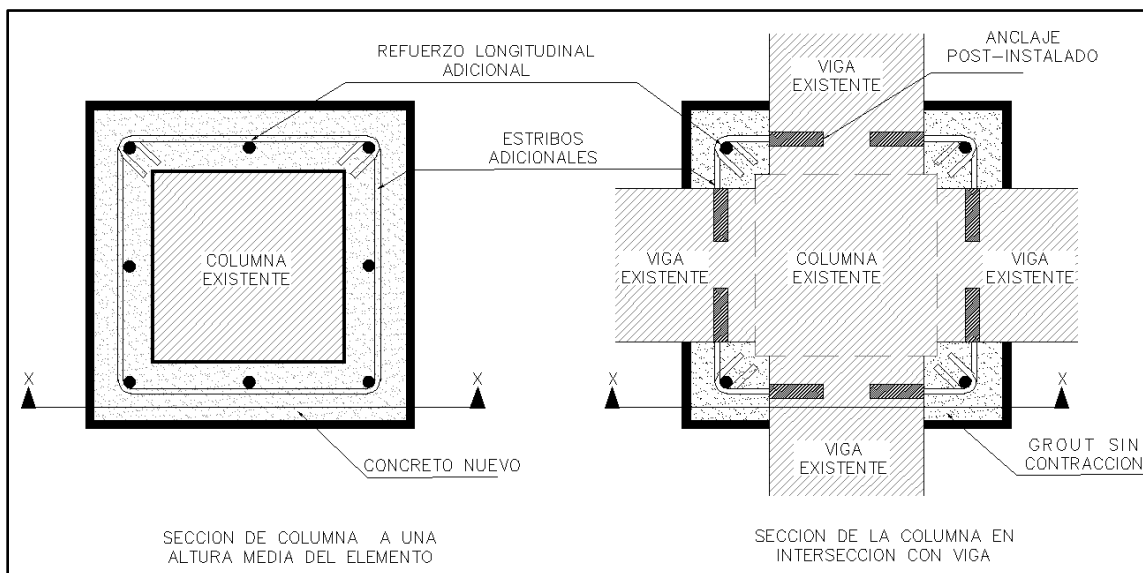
Sección transversal de detalles típicos del encamisado de columnas.
